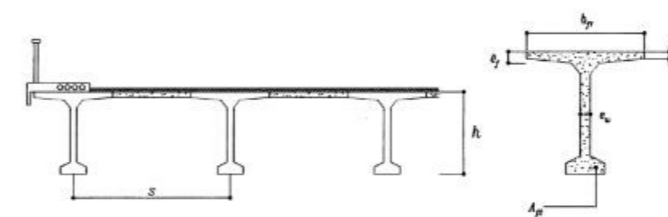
Sección transversal puente de vigas prefabricadas en doble T
